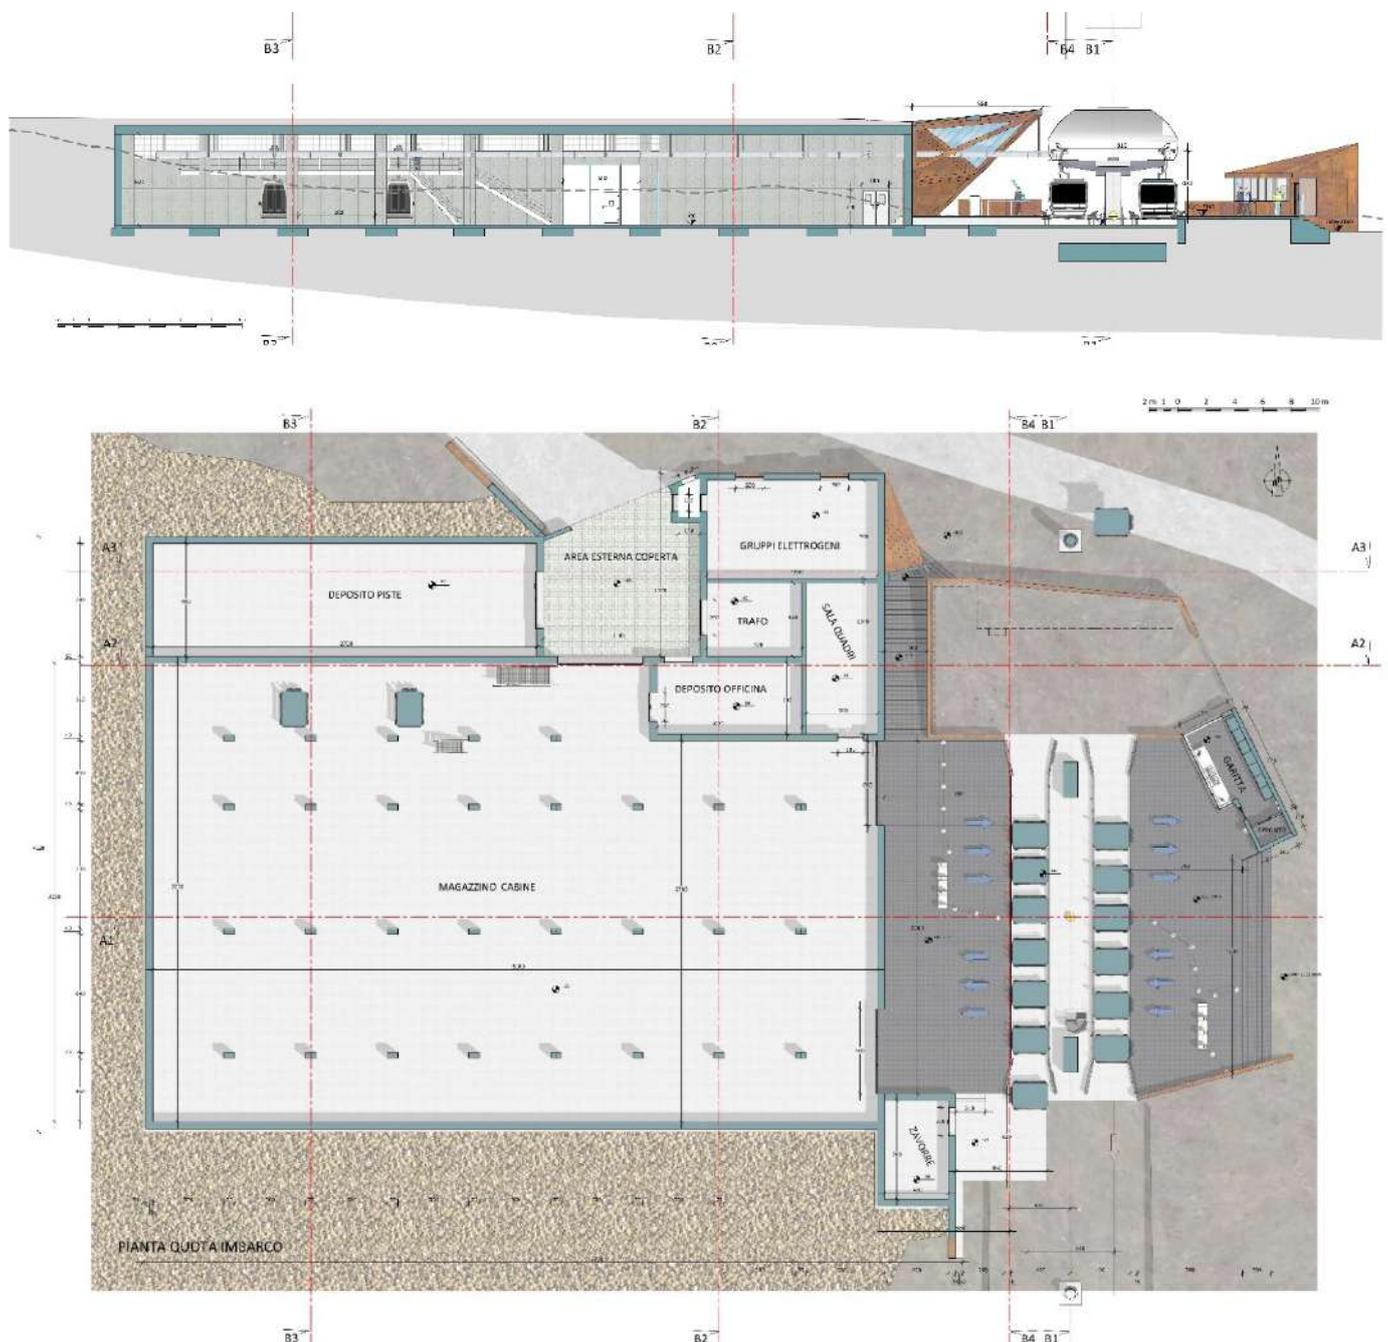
PIANTE E SEZIONE NUOVA STAZIONE INTERMEDIA COUIS CON MAGAZZINO CABINE
